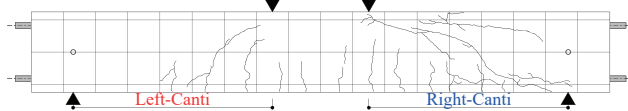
(c) 試験体 GS-30-Shear の最終ひび割れ図
